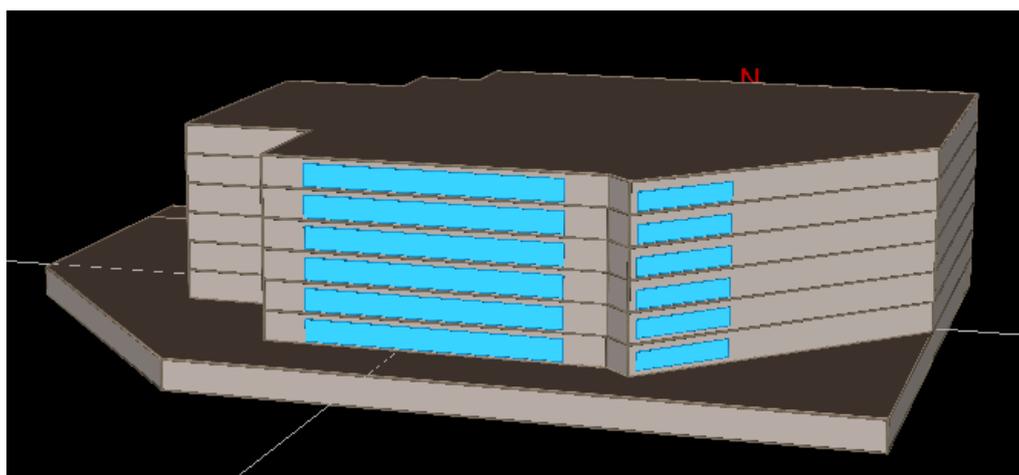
Vista 3D ECI de Albacete (fachada sur)
